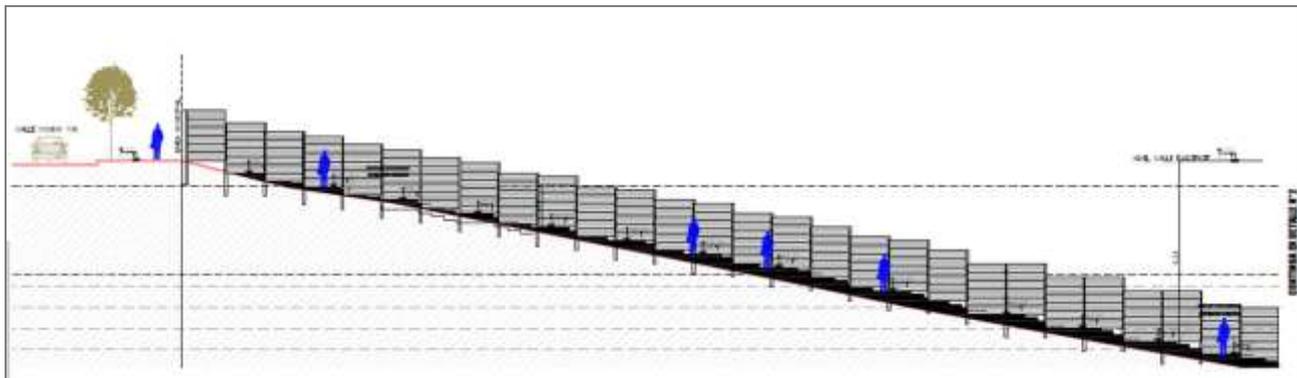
Detalle de los escalones y paredón de hormigón del circuito aeróbico
